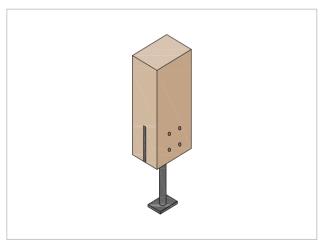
Esempio di collegamenti pilastro-fondazione
